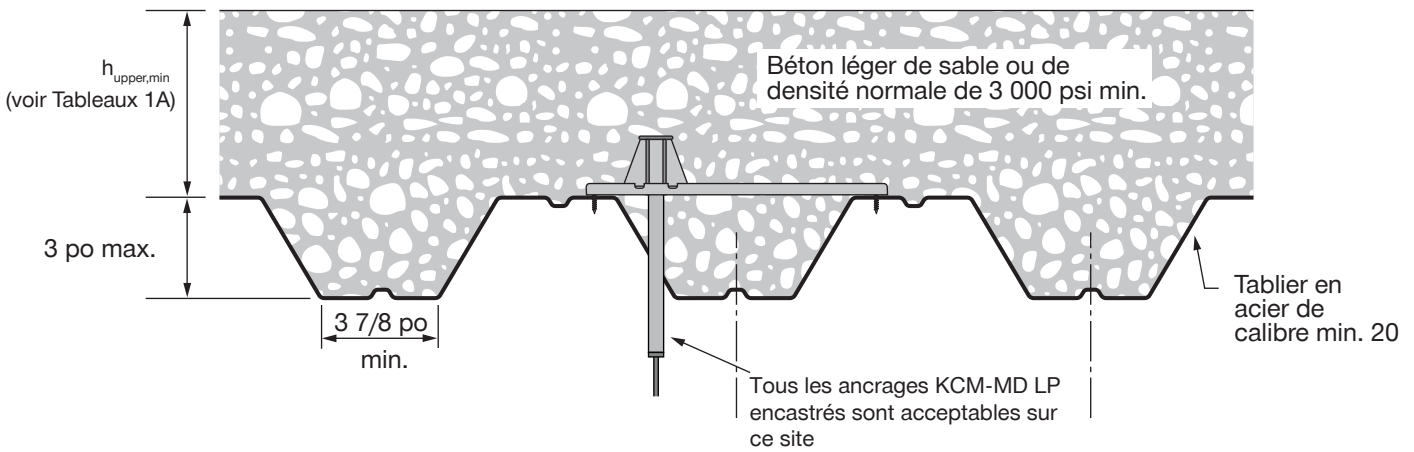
D – Installation dans le soffite d'un plancher ou d'un toit en béton sur tablier métallique sur l'angle de la cannelure supérieure (tablier « W »)
